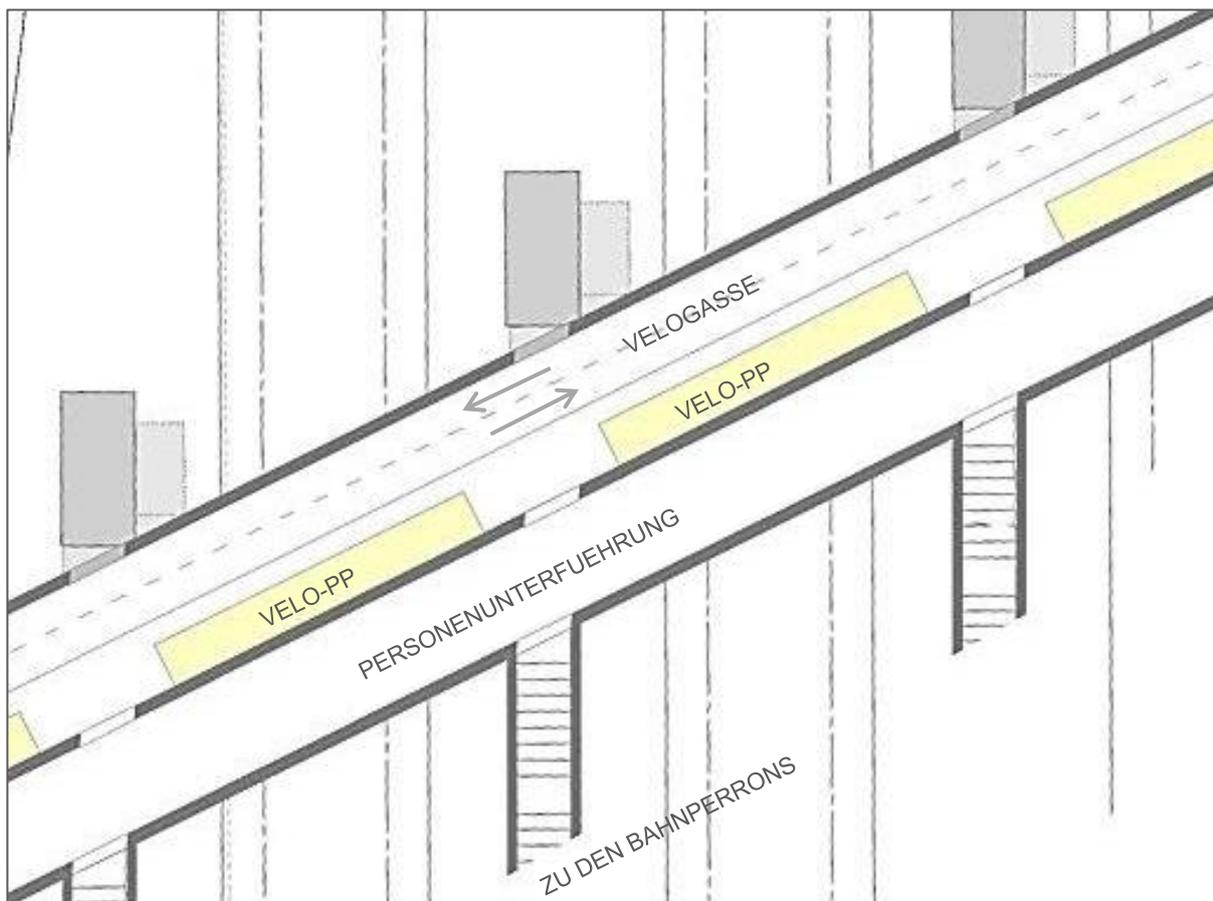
Ausschnitt Grundriss UG Bahnhof SBB mit ehemaligem Post-Tunnel und Personenunterführung
